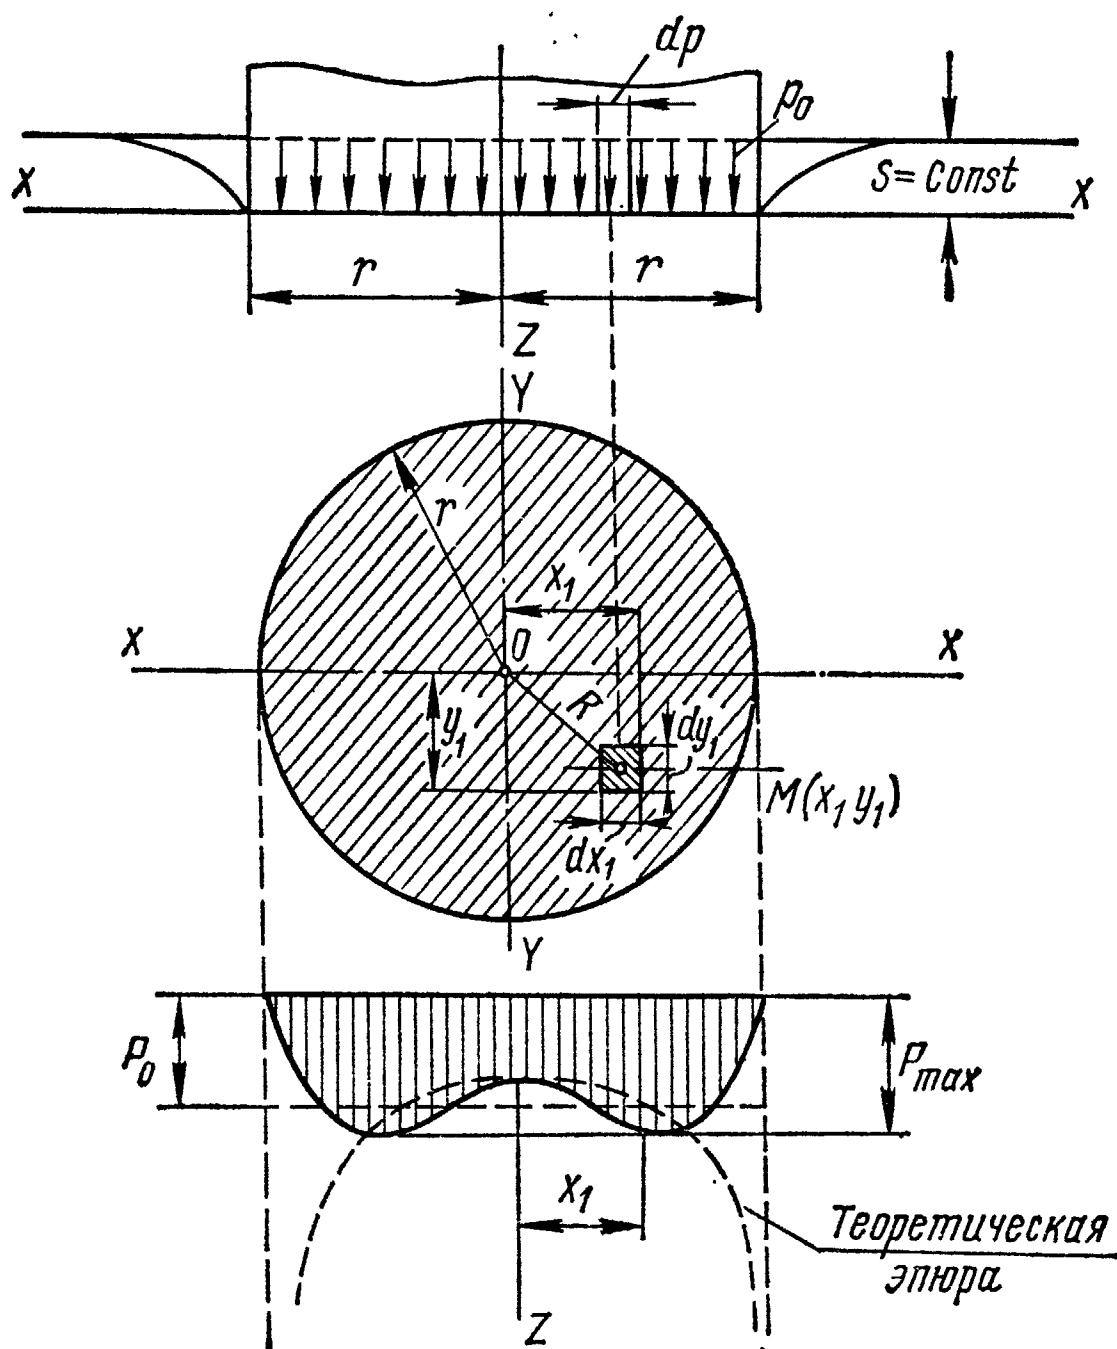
Напряжение в грунте под круглой площадью фундамента
